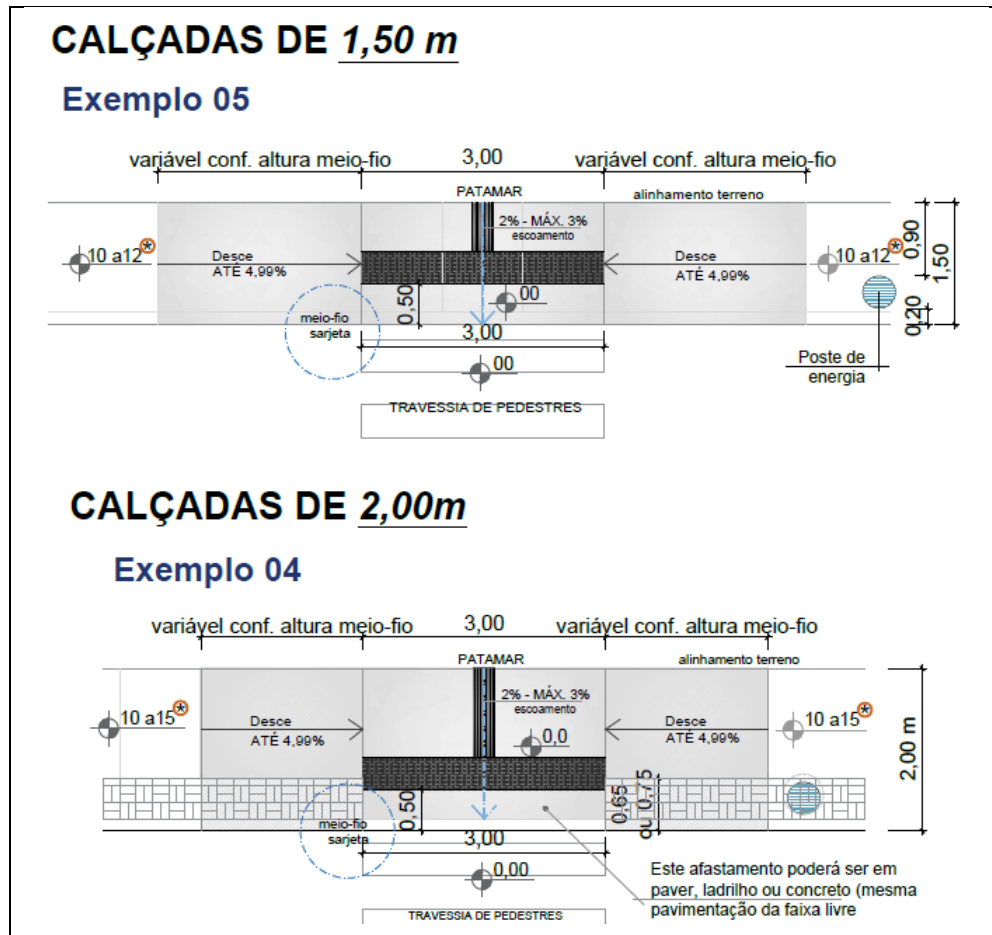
Detalhe rampas acessíveis em calçadas estreitas
